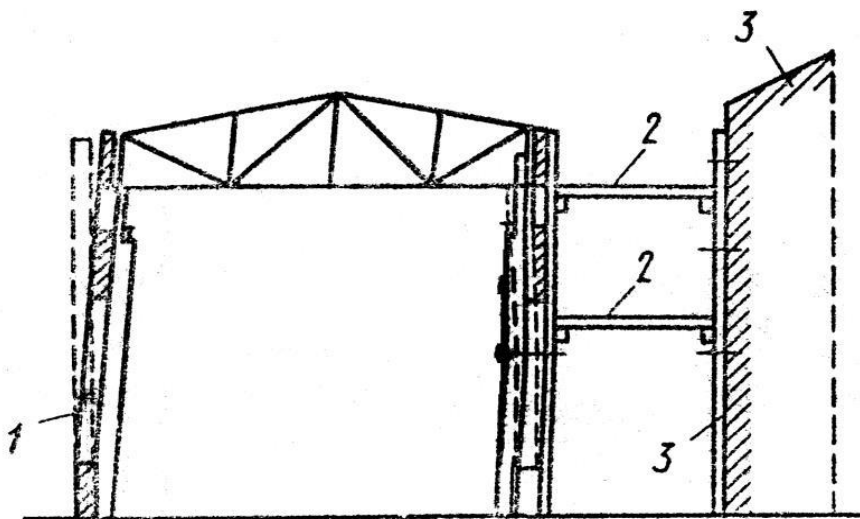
Крепление наклонившейся стены к стенам устойчивых зданий:
